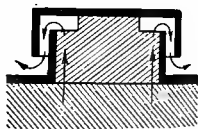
Схема вентиляционного светонепроницаемого колпачка
